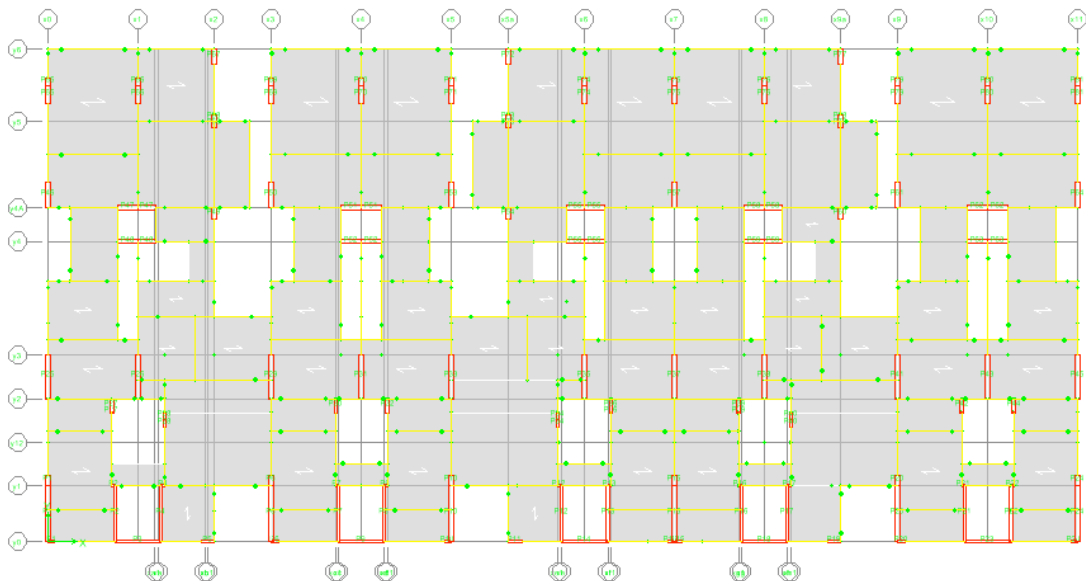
e Distribución en planta de vigas, columnas, placas y losas utilizado en el análisis para un piso típico
